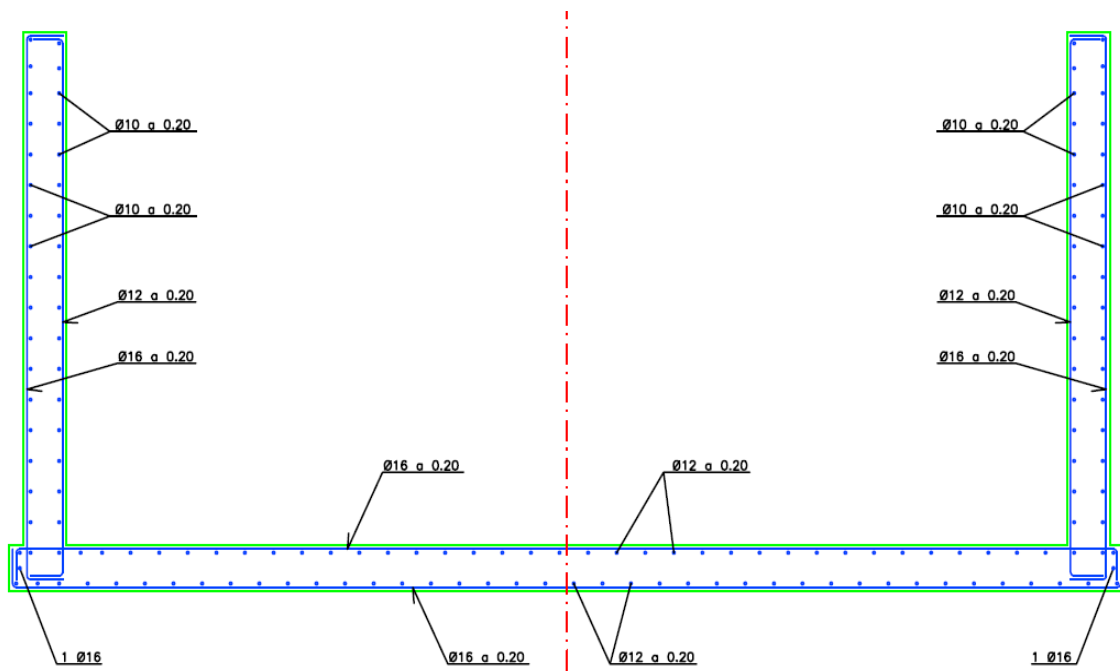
Detalle armadura sección tipo 5 ((Proyecto de refuerzo estructural del canal de desvío del arroyo Calzas Anchas. t.m. de Utrera (SEVILLA)).
